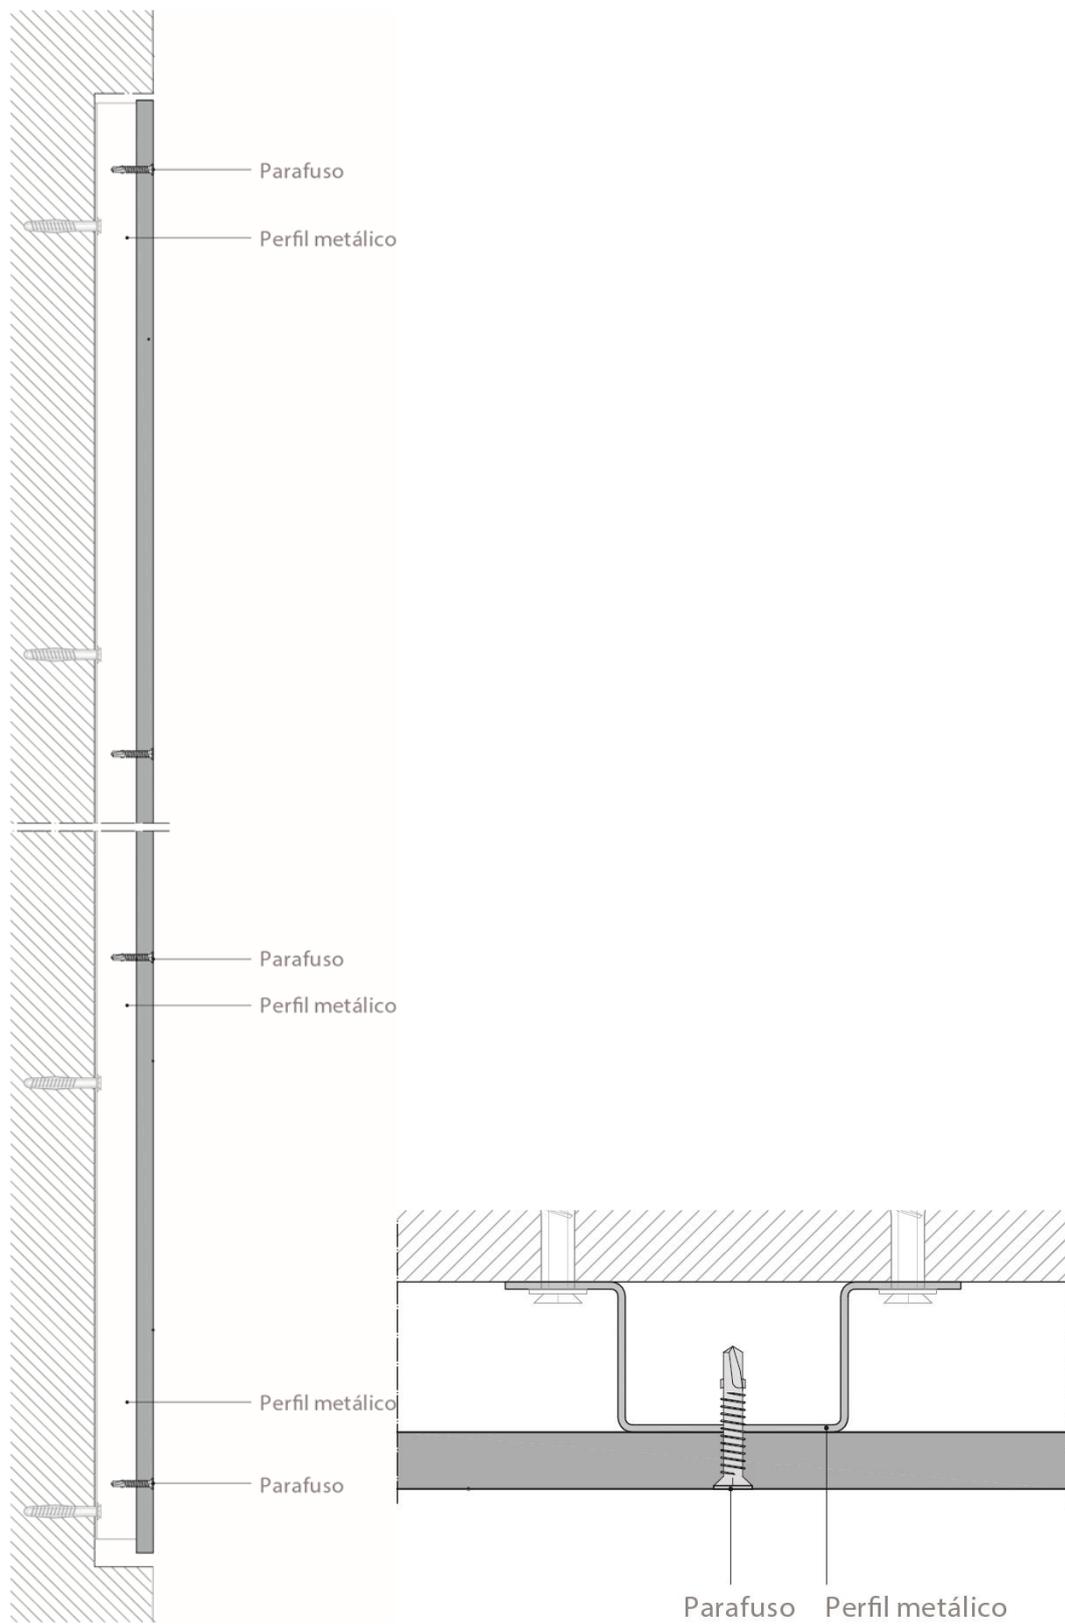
corte vertical de estrutura, pormenor de fixação dos perfis
